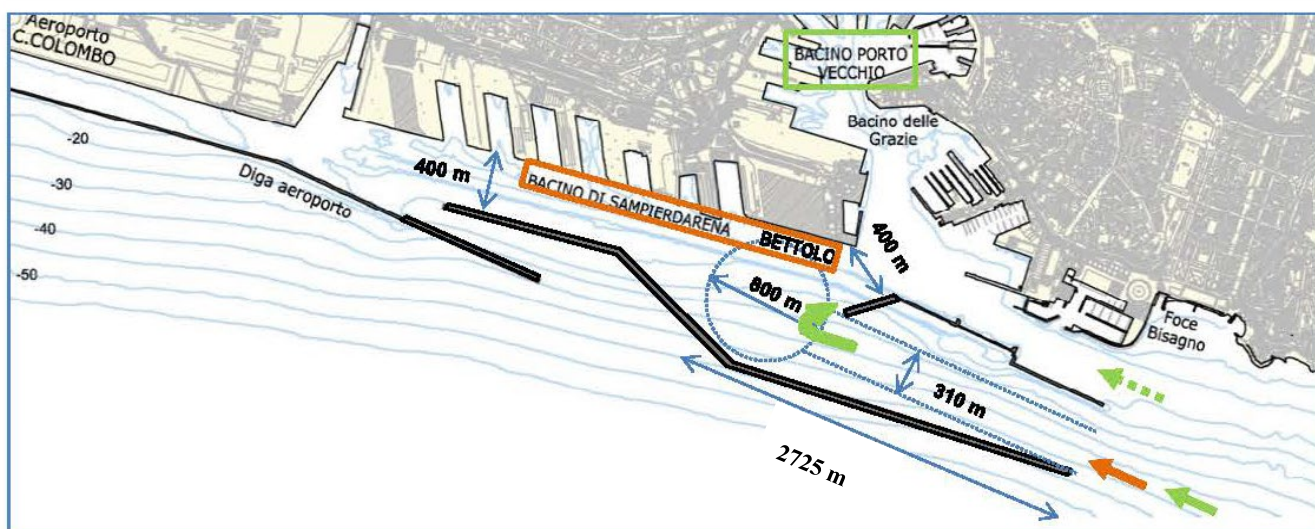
PLANIMETRIA DELLA NUOVA DIGA FORANEA NELLA SUA CONFIGURAZIONE FINALE
